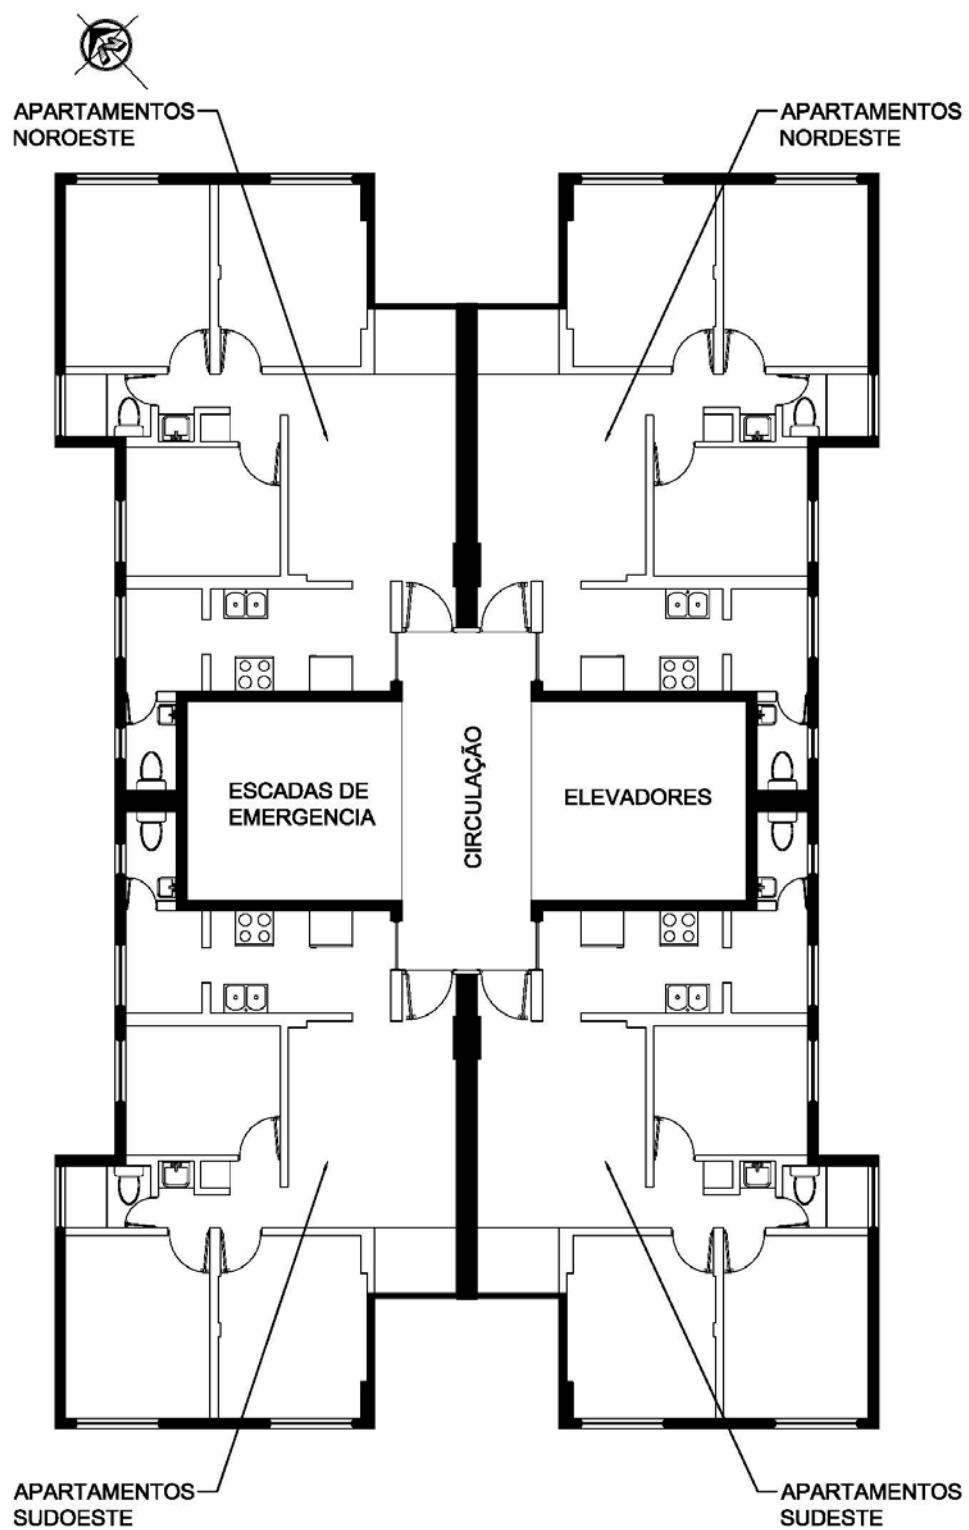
Planta típica distribuição de apartamentos, edificação de estudo.
